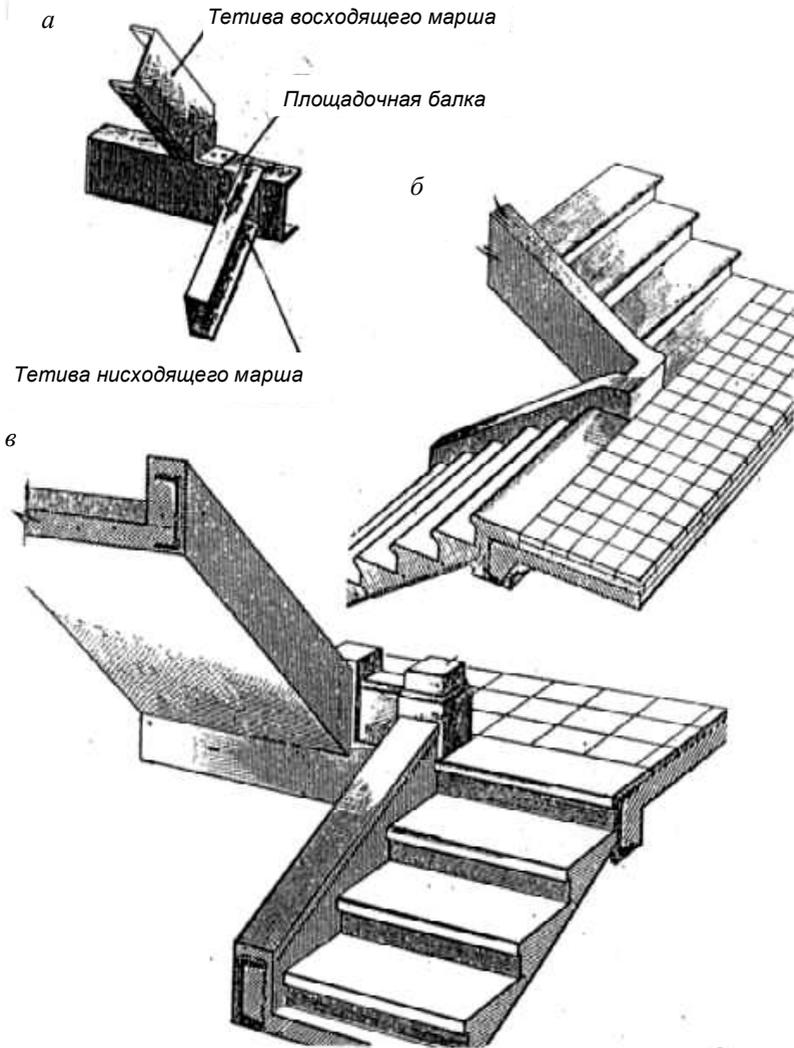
Лестницы на обетонированных стальных тетивах:
